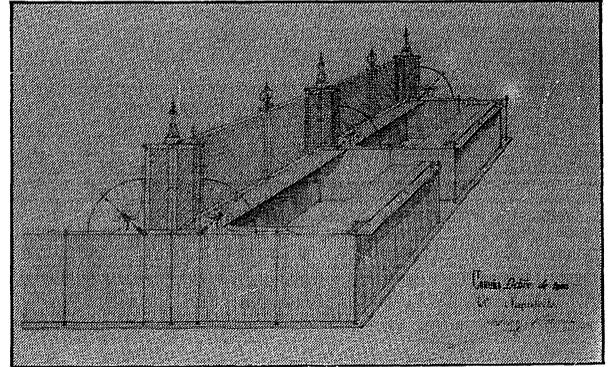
Fachada interior del pabellón Sur del proyecto de mercado para la Plaza de Lugo de Pedro Mariño.
